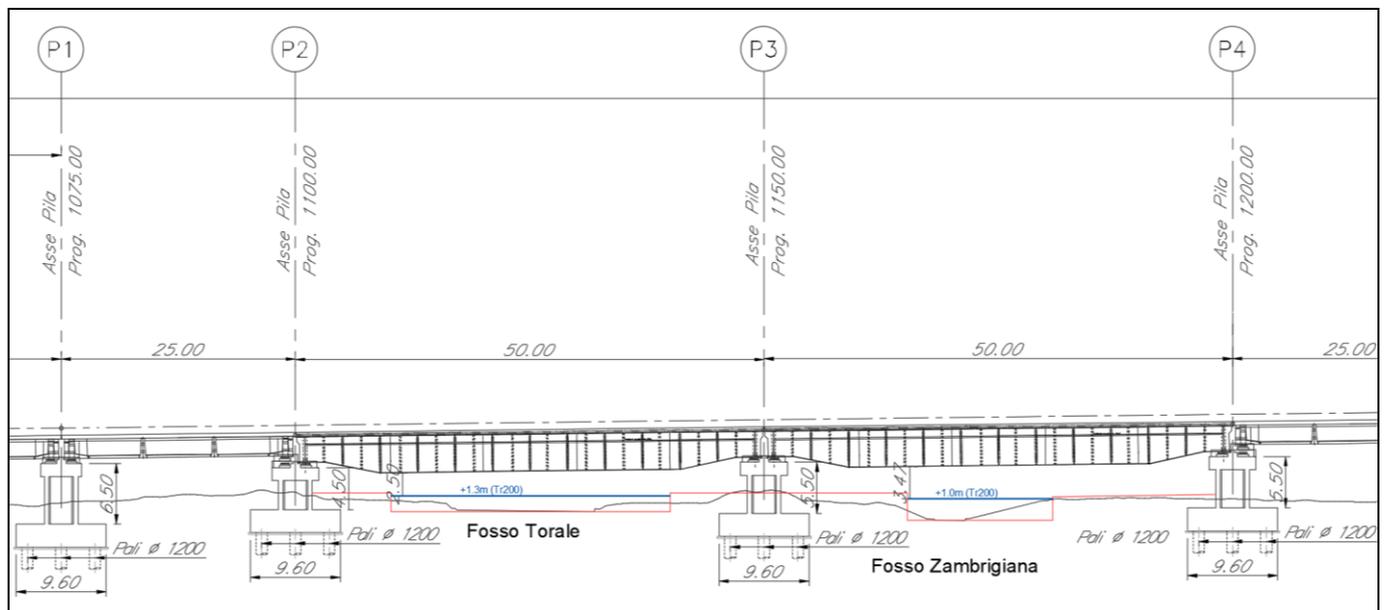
Prospetto del viadotto VI05 con livelli idrici di riferimento (Tr200) e riprofilature dell'alveo in progetto.
